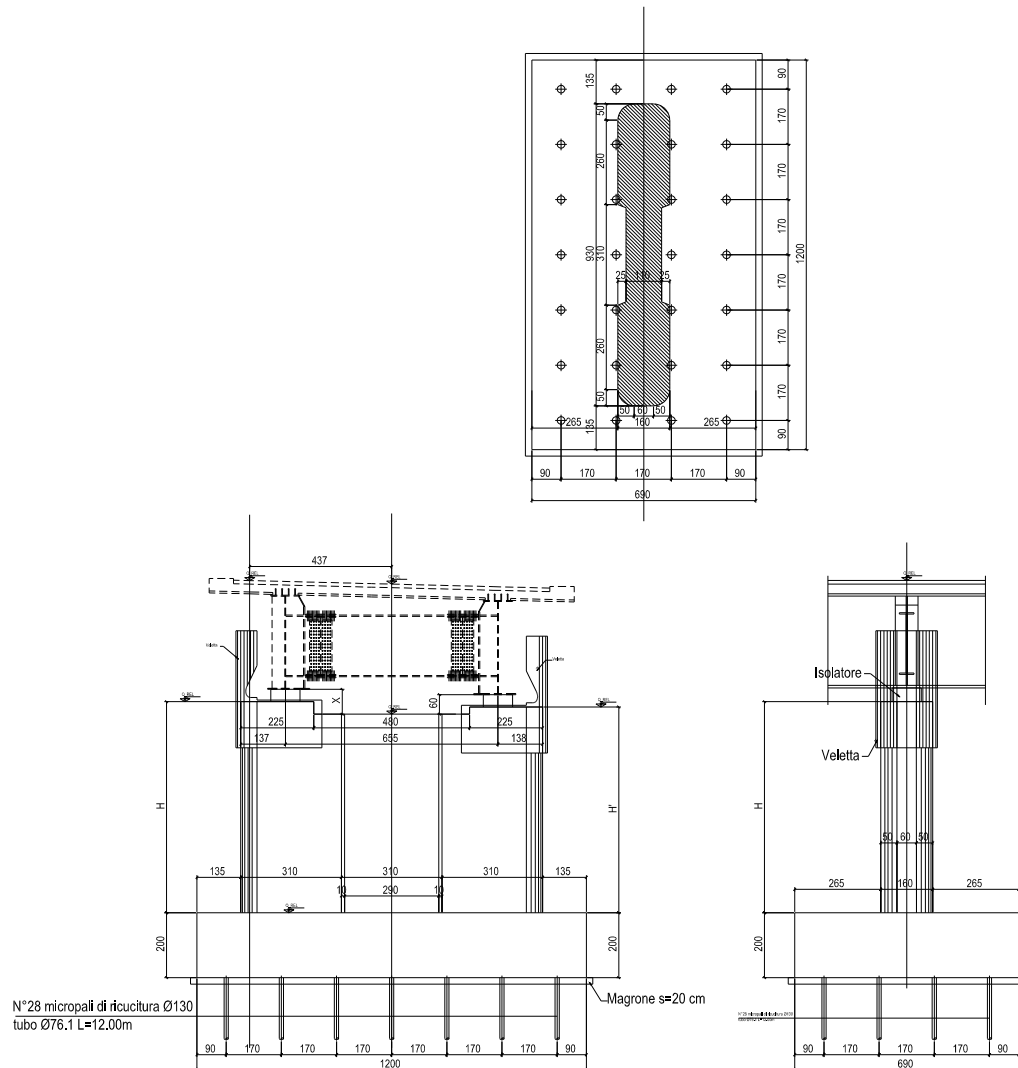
Sezione trasversale, vista trasversale e longitudinale delle pile 3 e 4
